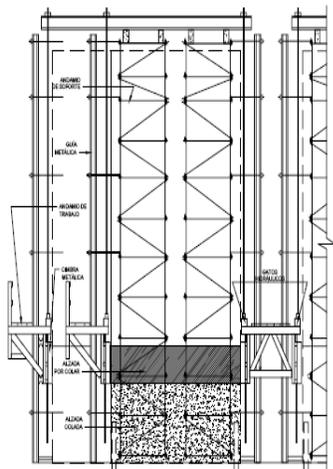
Zona de ubicación y disposición de la cimbra deslizante
